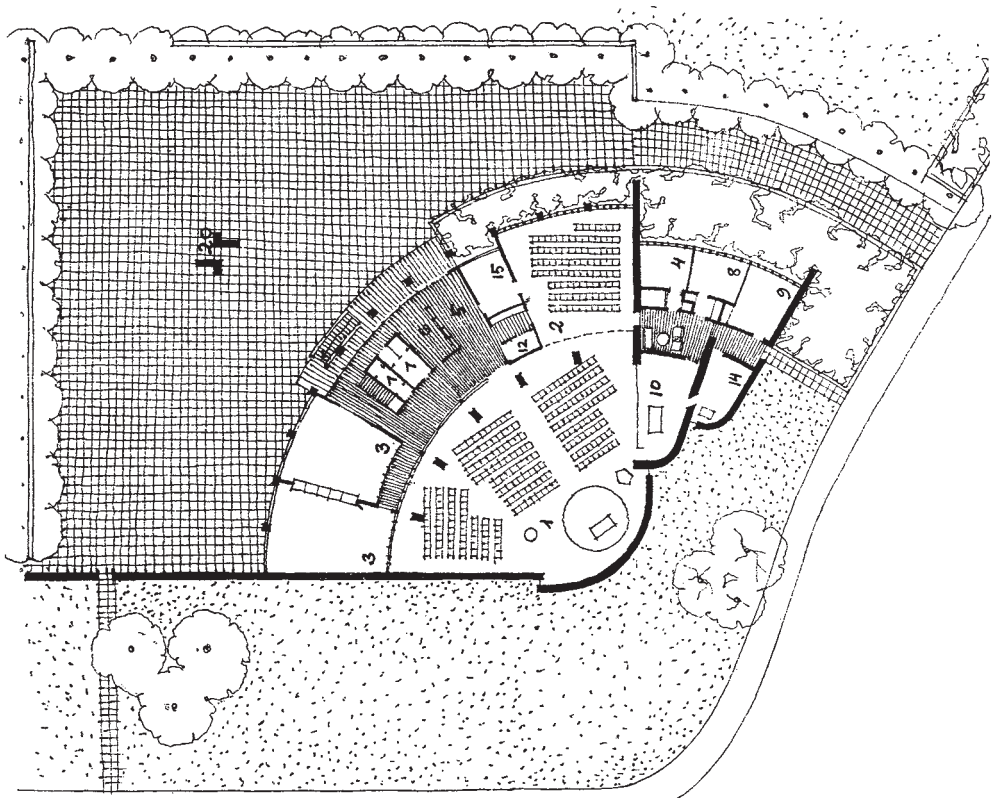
Grundplan og situationsplan. 1:600. Forslag ved Holger Jensen 1973. Efter *Haderslev Stiftsbog* 1976. – *Ground plan and situation plan. Proposal by Holger Jensen, 1973.
